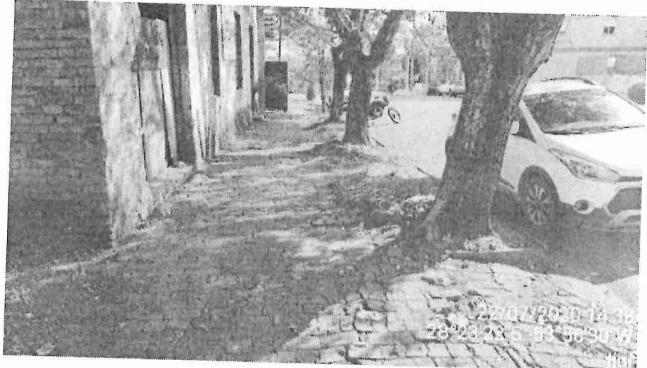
Detalhe Pavimento deteriorado e Vegetação de grande porte, Bordo direto Trecho 01.
